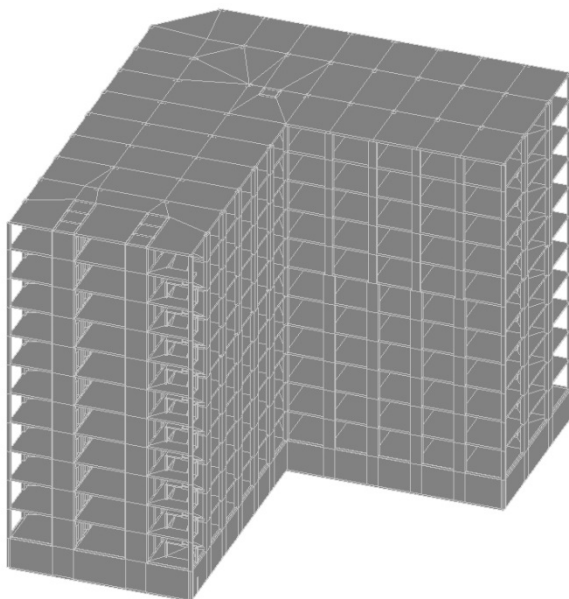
Багатоповерхова будівля з залізобетонним каркасом
